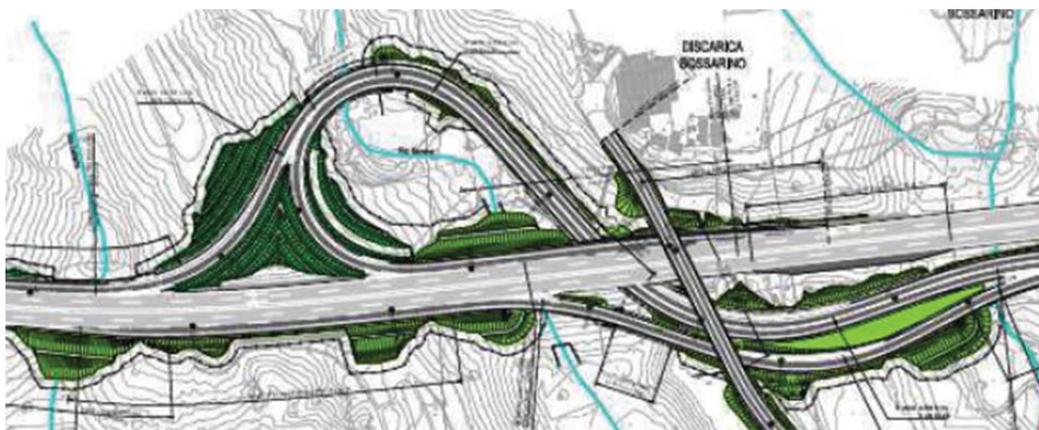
Stralcio della planimetria dello svincolo autostradale in progetto.
